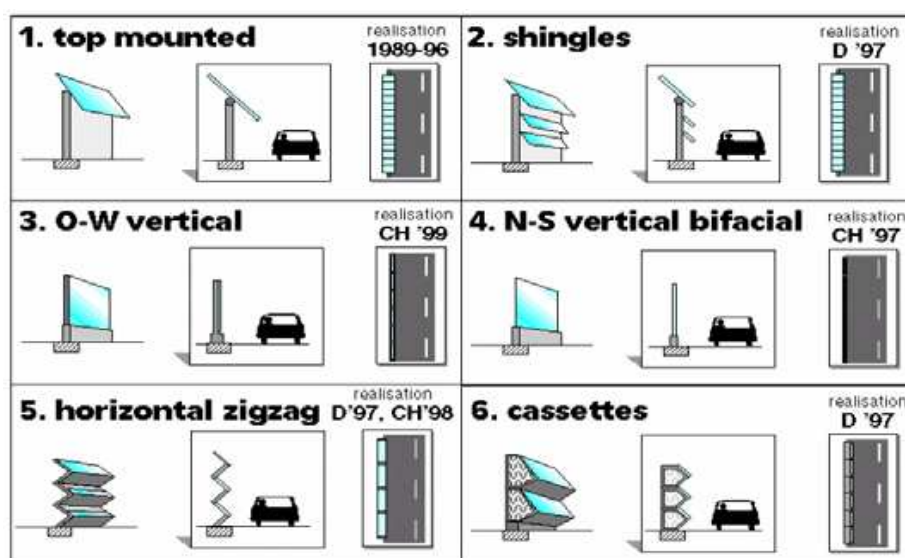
Diferentes Configurações de Barreiras Sonoras aplicando Painéis Fotovoltaicos (Nordmann,T. Et al)
